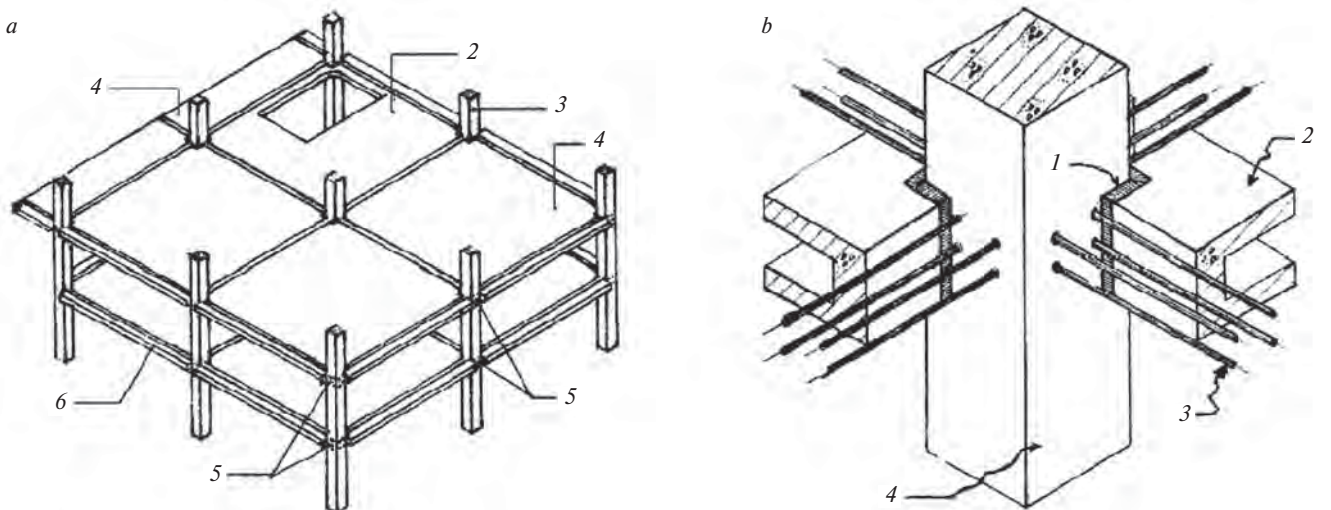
Несущий каркас системы «КПНС» с натяжением рабочей арматуры в построечных условиях для многоэтажных гражданских зданий; а – принципиальная конструкция каркаса: 1 – консольное перекрытие; 2 – перекрытие с отверстием для лестницы; 3 – колонна; 4 – типовое перекрытие; 5 – натягаемая канатная арматура; 6 – фасадная распорка; б – конструкция узла примыкания плит перекрытия к колонне: 1 – контактный шов; 2 – плита; 3 – канат К-7, скрытый в теле монолитного ригеля; 4 – колонна
